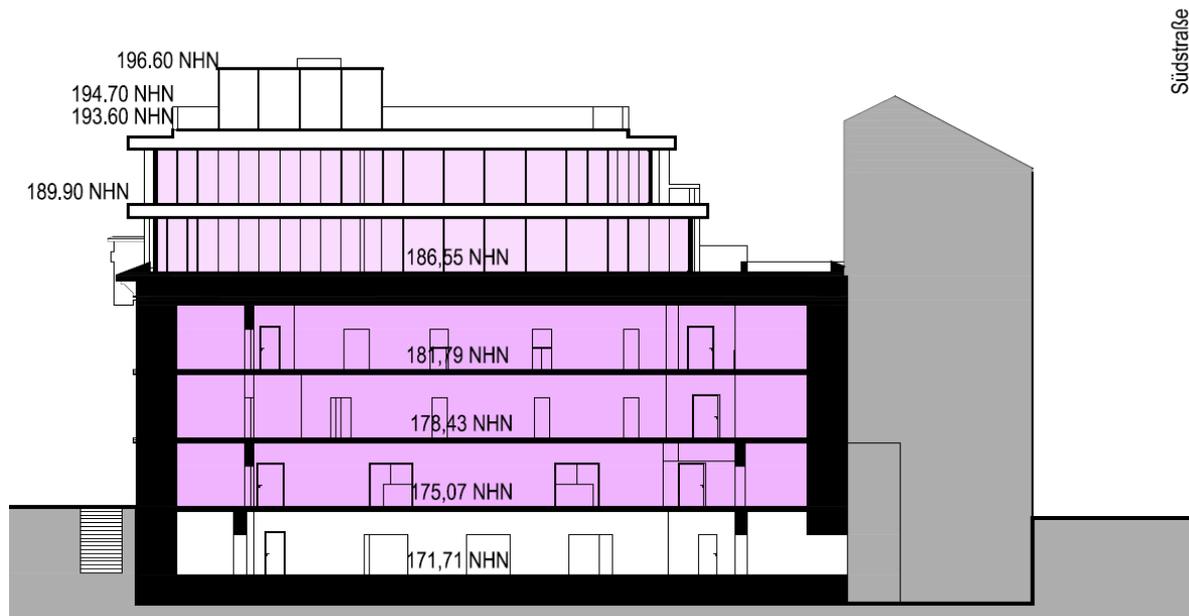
Gebäudeschnitt Bereich Bunker; Entwurf, Stand 15.06.2022
